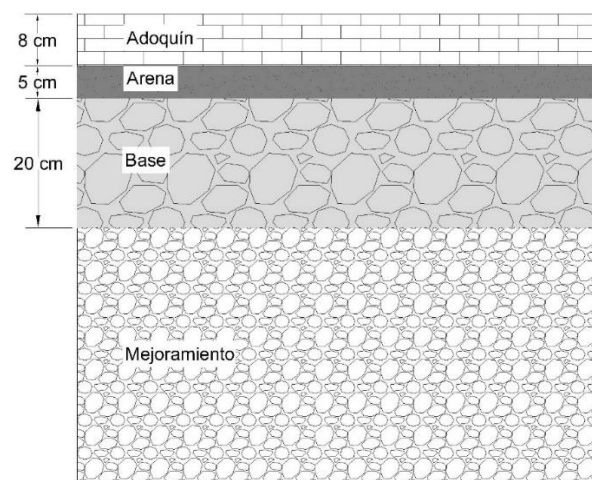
Estructura del pavimento. Fuente: (Andrade S. & Carranza R., 2019)
